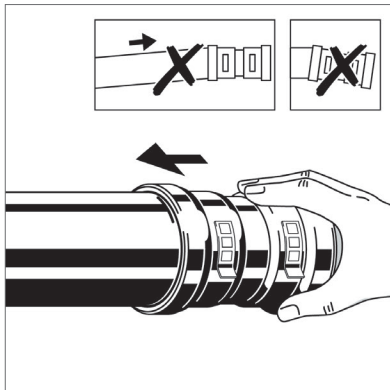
Pressverbinder - ohne zu verkanten - bis zum Anschlag auf das Rohr schieben.
